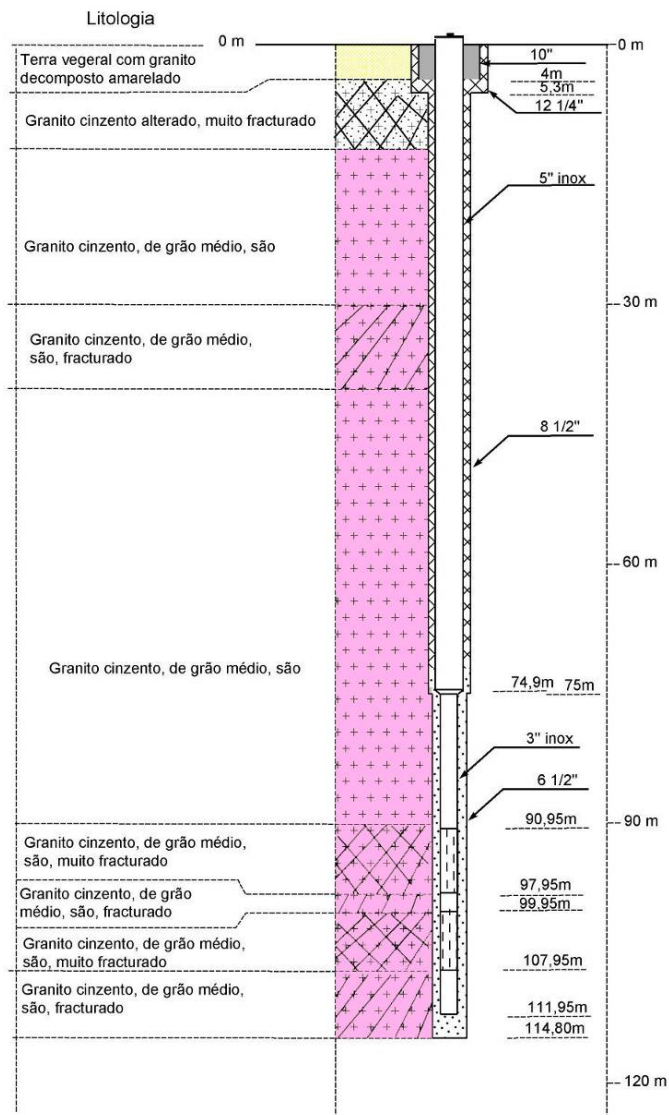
Perfil esquemático do Furo AC2 (adaptado de A.Cavaco, 1990).
